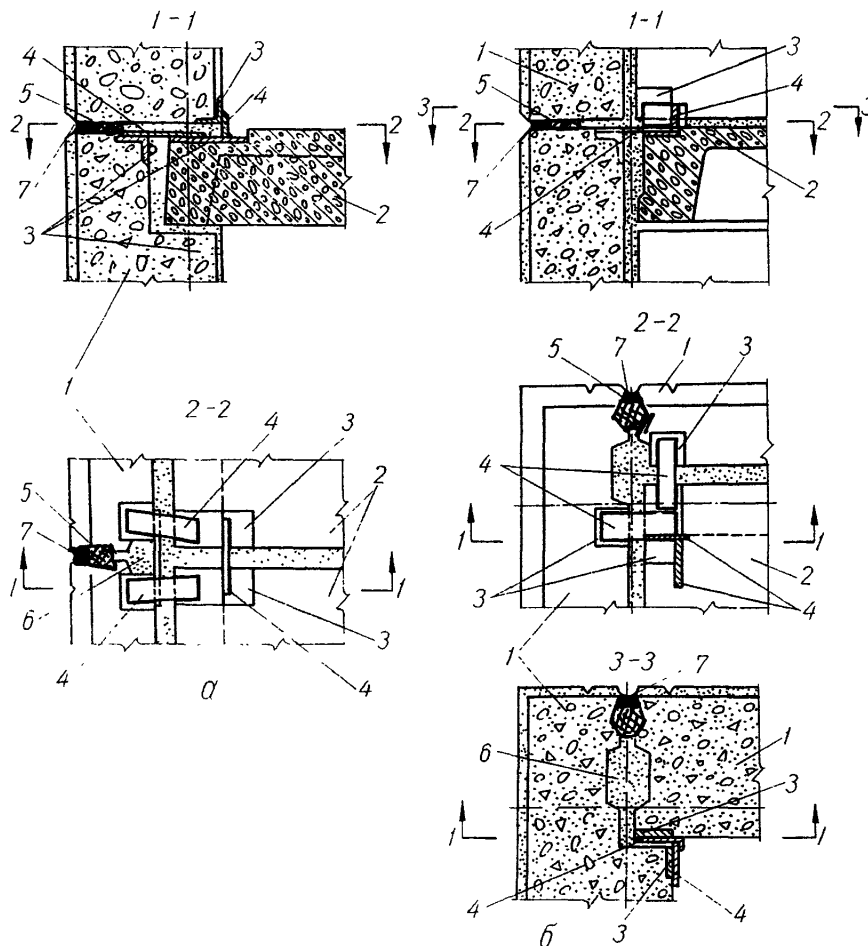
Конструкция стыков на сварке закладных деталей
